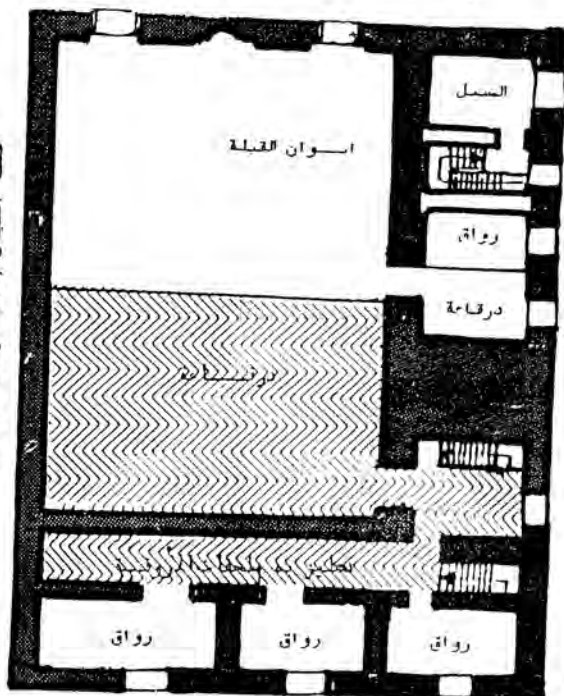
مسقط الخي (تخلى) للدور الأرضي سفلى المسجد
